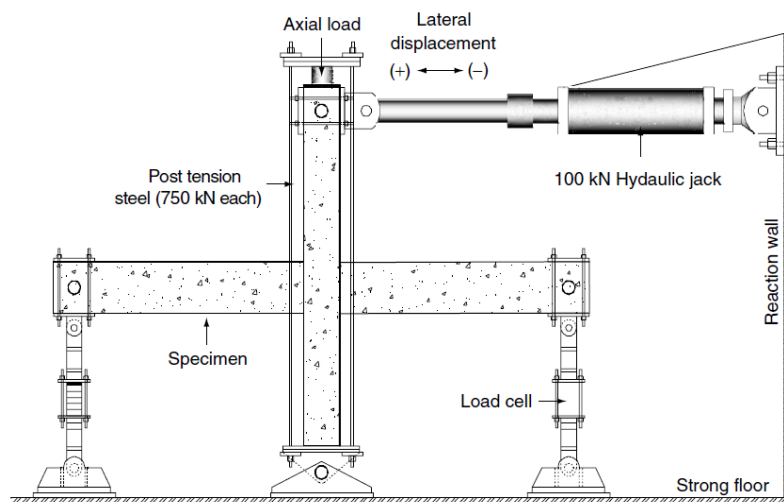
Ensamblaje ensayo (Meas et al., 2014)
